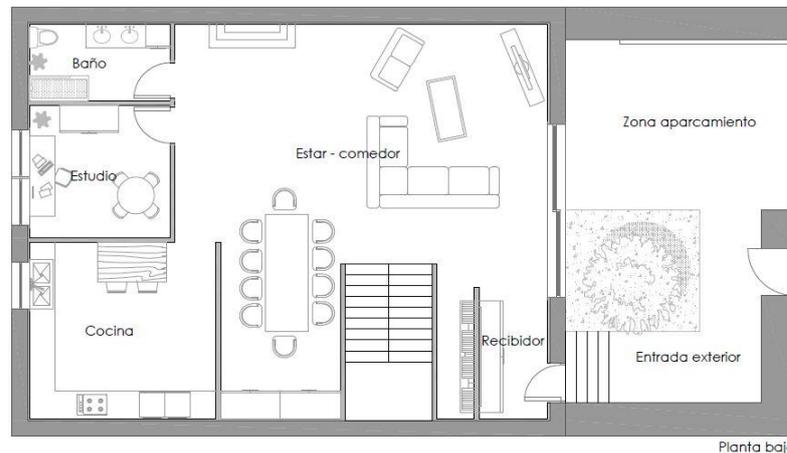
Distribución planta baja. Fuente: Elaboración propia.
